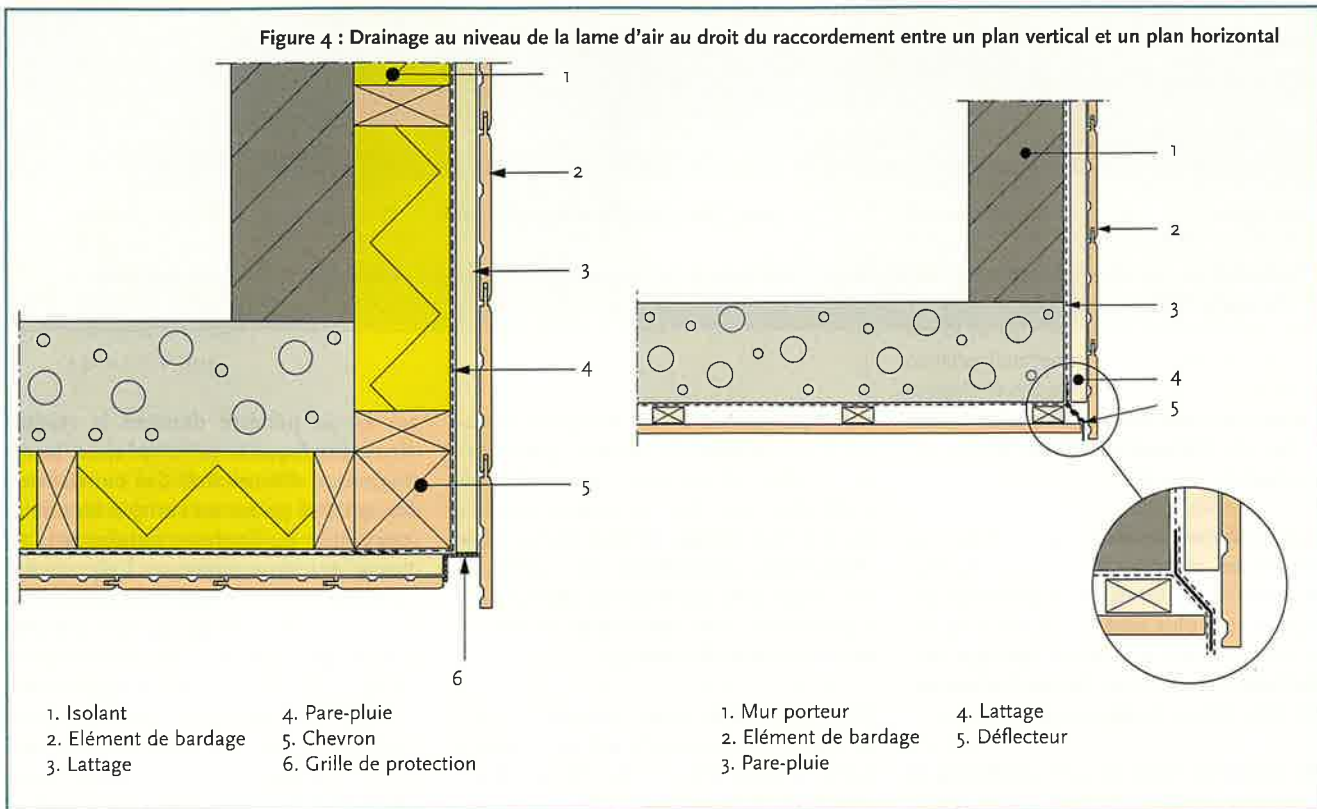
Drainage au niveau de la lame d'air au droit du raccordement entre un plan vertical et un plan horizontal
